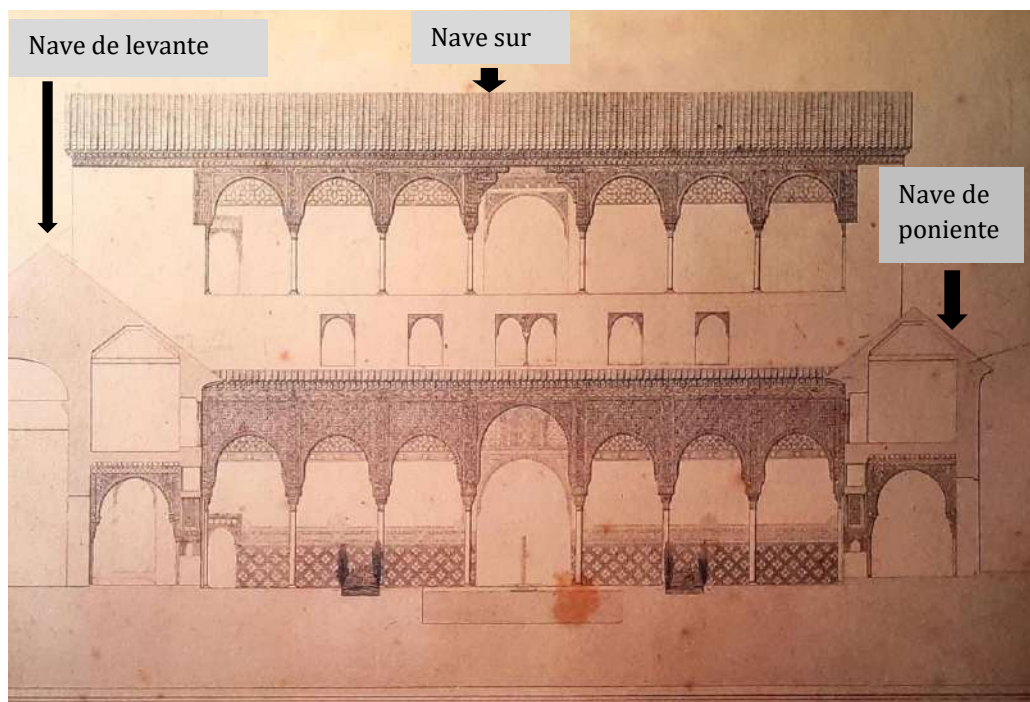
Sección del Patio de Arrayanes hacia la galería sur. Owen Jones y Jules Goury, 1842. (*PLANOS, ALZADOS, SECCIONES Y DETALLES DE LA ALHAMBRA*).
